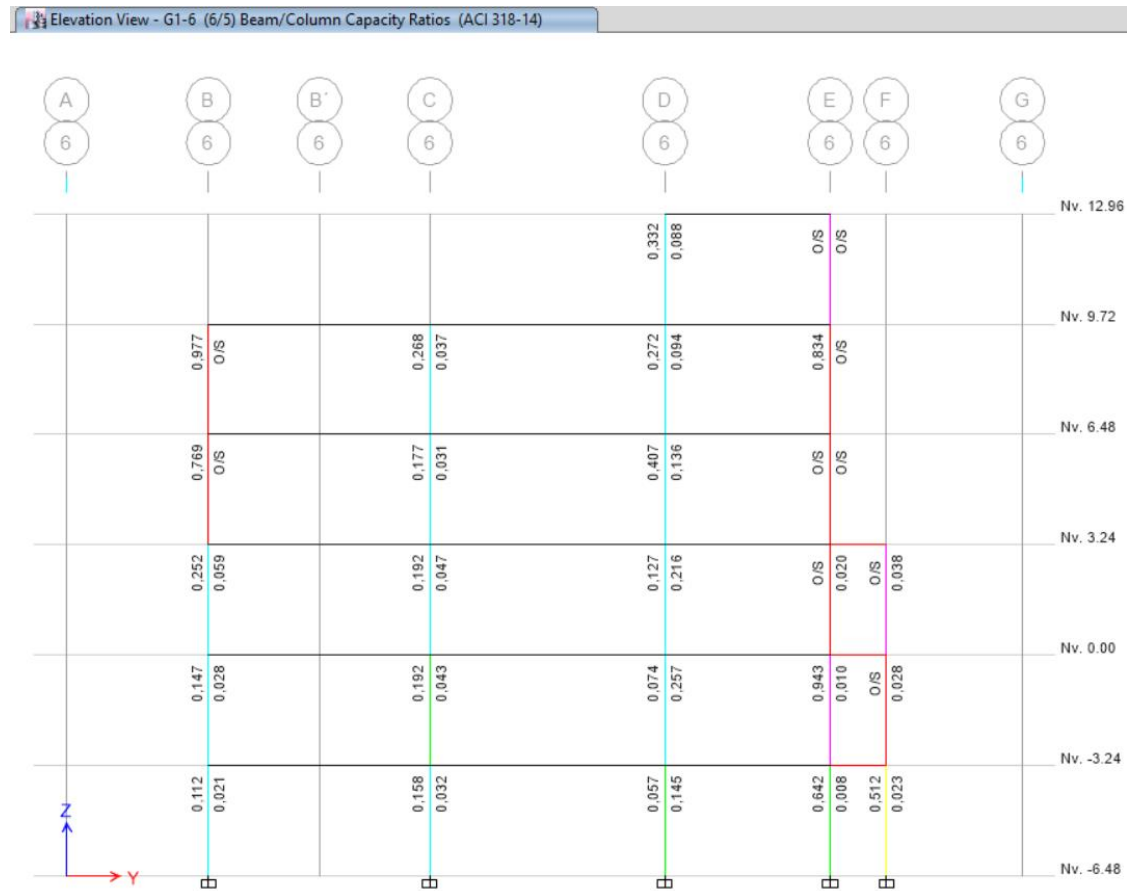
Vista en elevación de factor de capacidad unión viga-columnas, pórtico eje 5.
